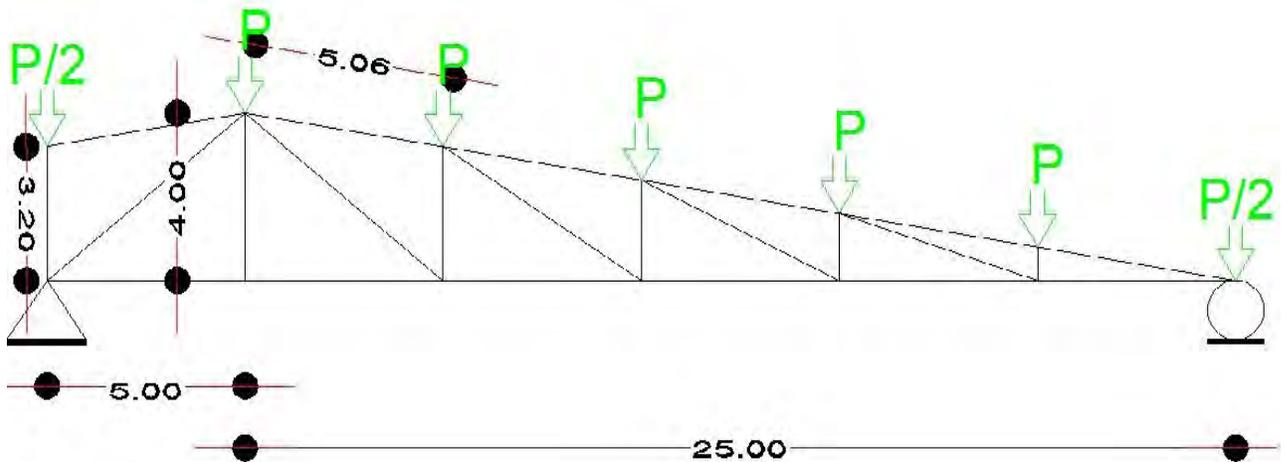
Propuesta de armadura para claro de 30 m y 2 apoyos.
